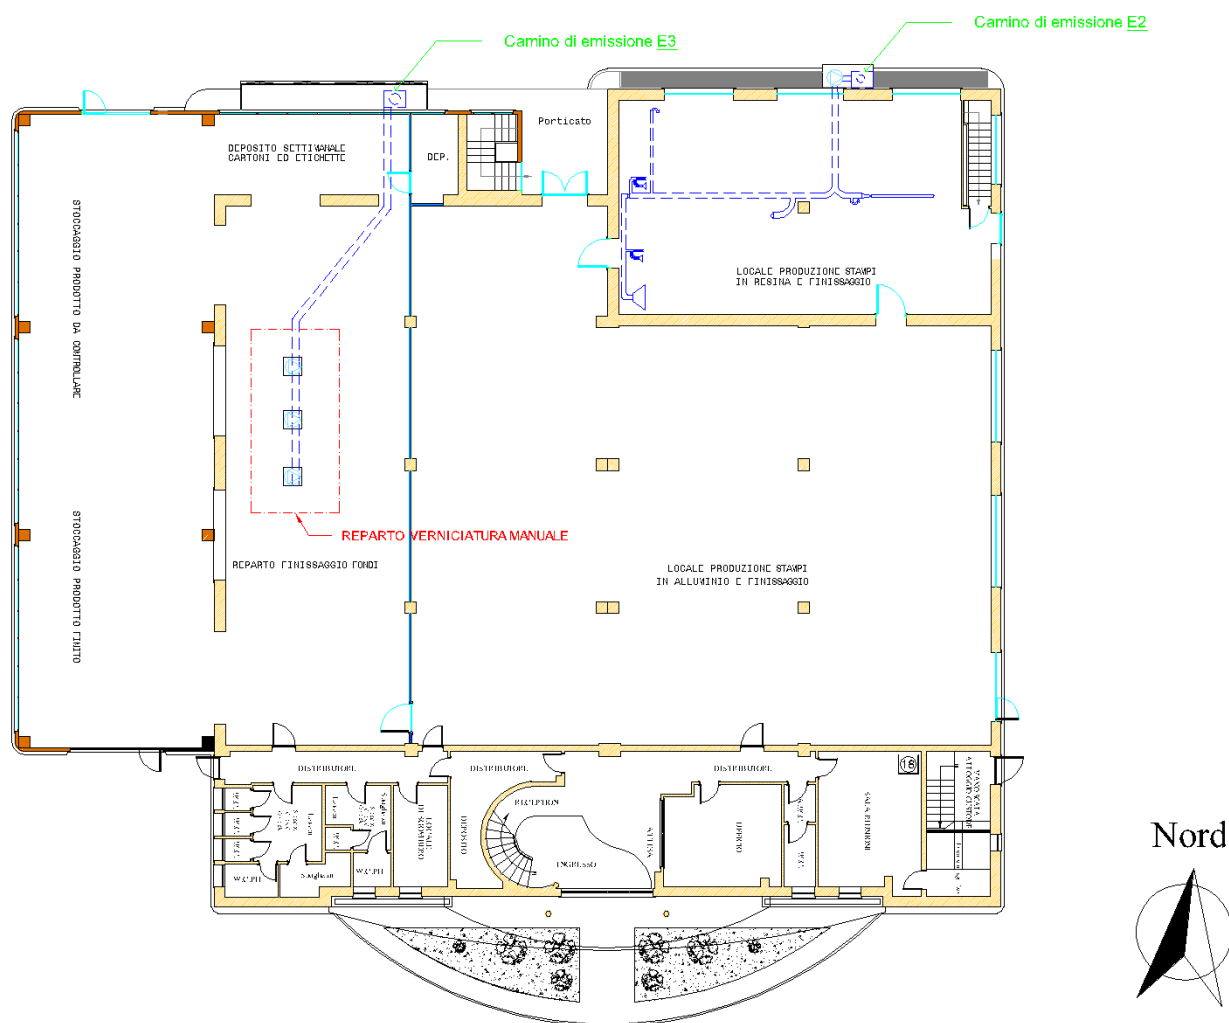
Stato di Progetto_planimetria piano terra capannone no.1
